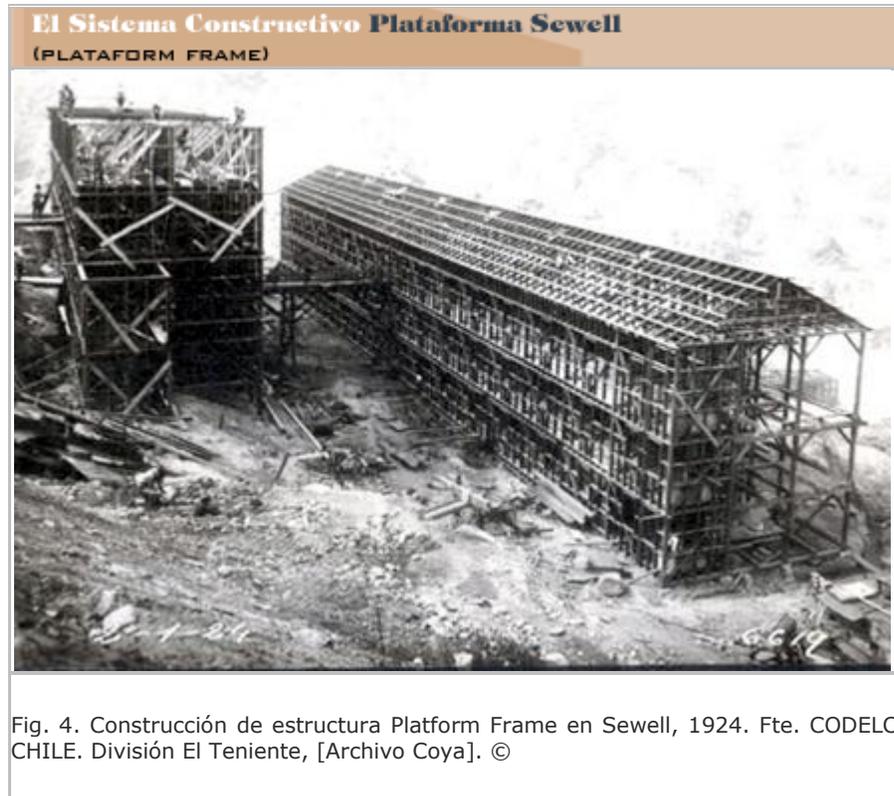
Construcción de estructura Platform Frame en Sewell, 1924.
